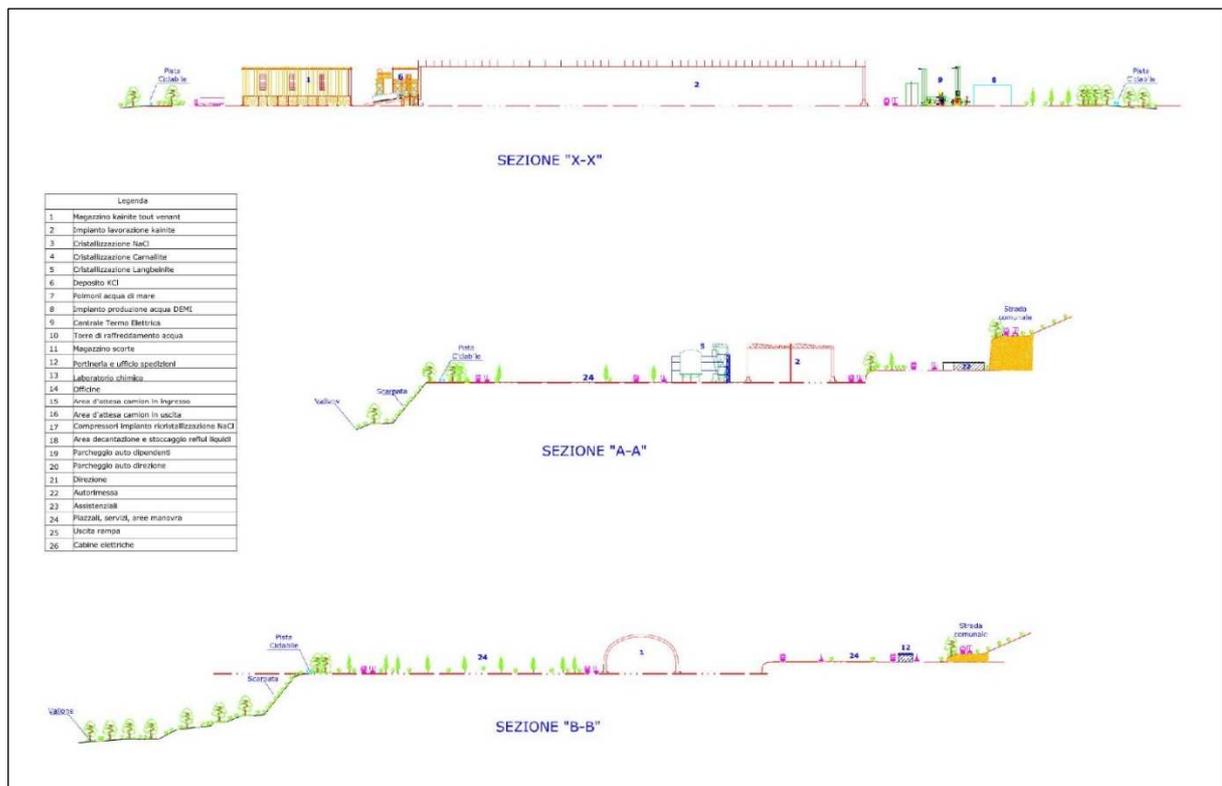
Sezioni (rif. planimetria generale) del complesso industriale in progetto.
